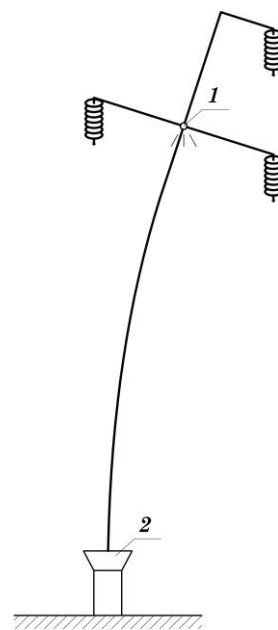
Устройство для контроля прогибов гибкой опоры
